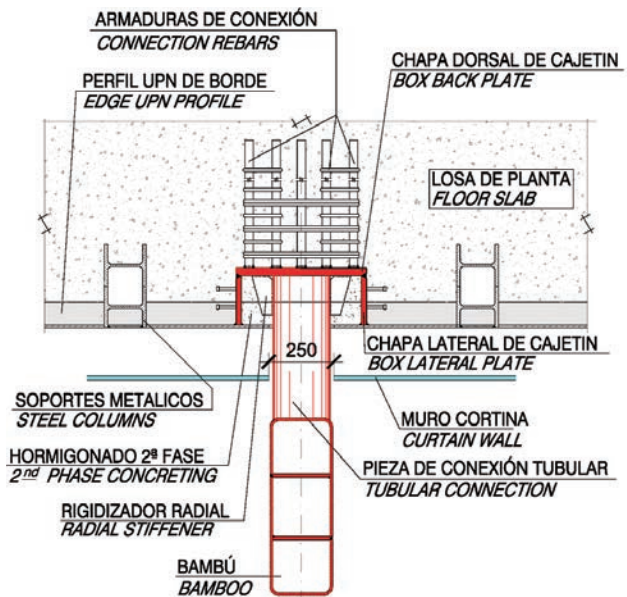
Planta de la conexión de los bambúes a las losas de planta (cotas en mm)
